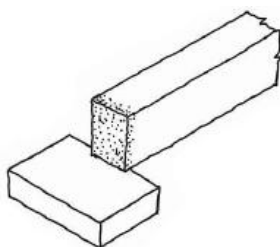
Corte da cabeça da viga (Arriaga) [21]
